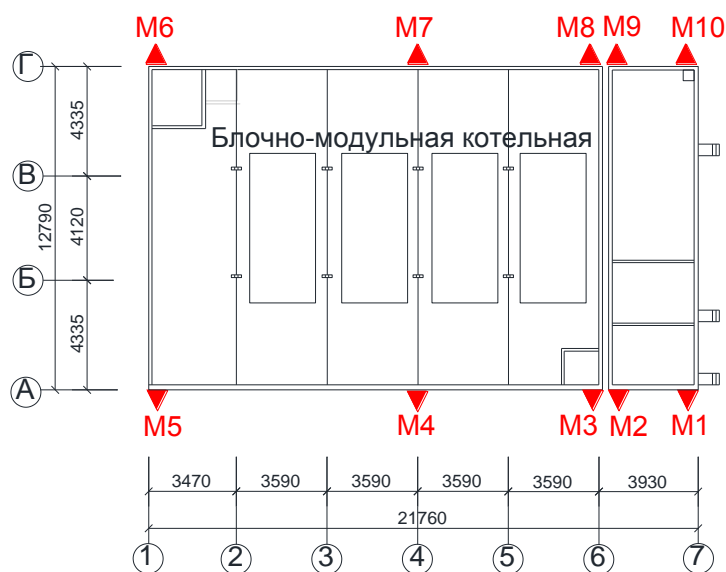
Схема установки осадочных марок на здании Блочно-модульной котельной
